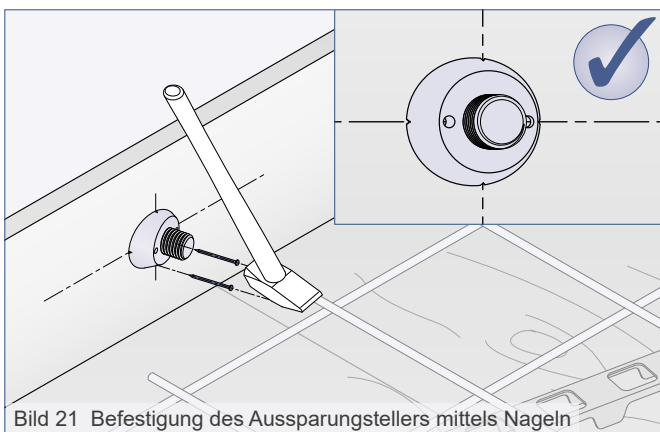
Befestigung des Aussparungstellers mittels Nageln
